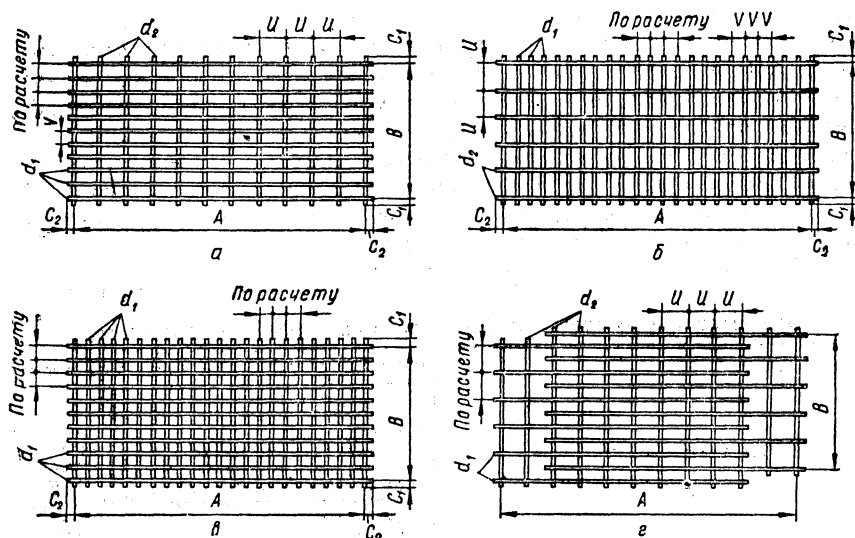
Расположение рабочей арматуры в сварных сетках:
